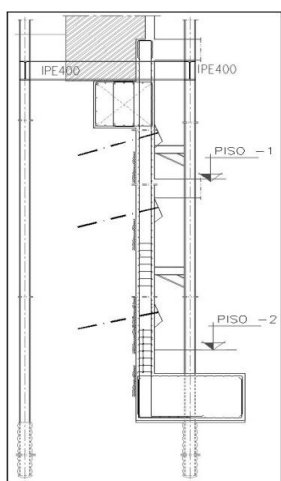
Corte na zona abaixo do piso térreo onde se observam os perfis de fundação [10].
